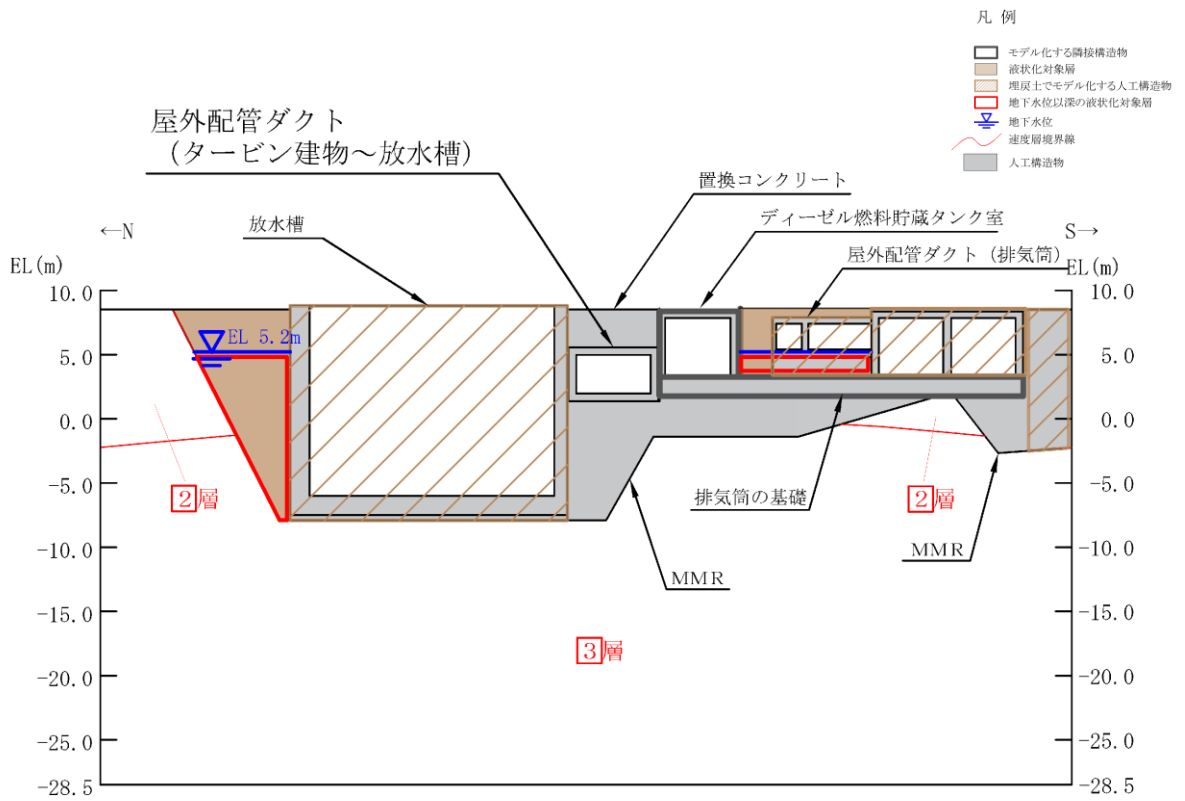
屋外配管ダクト (タービン建物～放水槽) 評価対象断面図 (A-A 断面位置)
